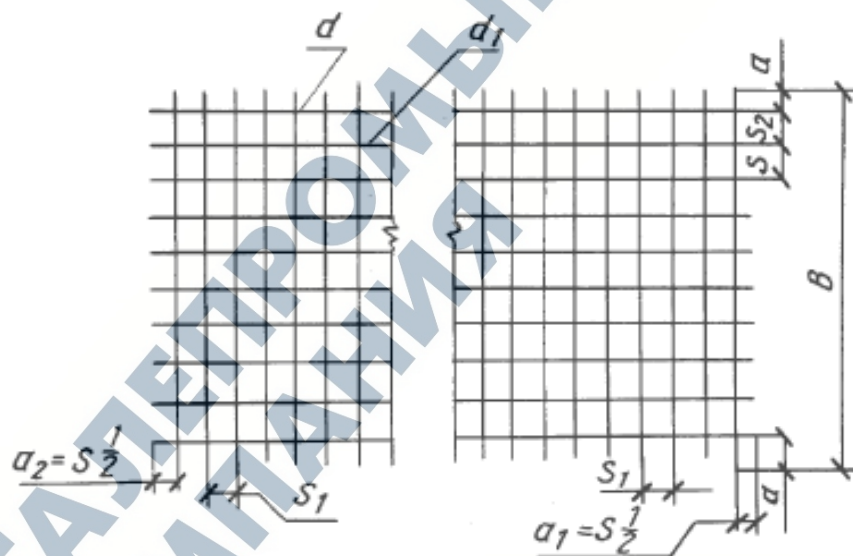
Сетка сварная для железобетонных конструкций по ГОСТ 8478-81
